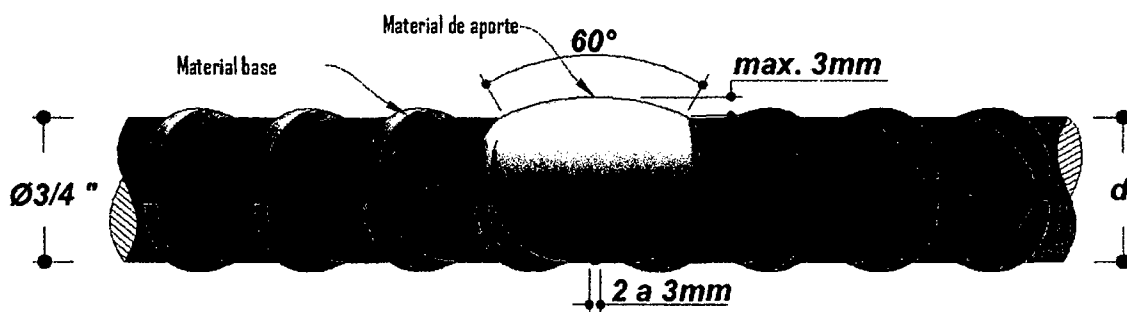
Detalle de terminado de soldadura a tope directo de barra de $\text{Ø} 3/4''$.
